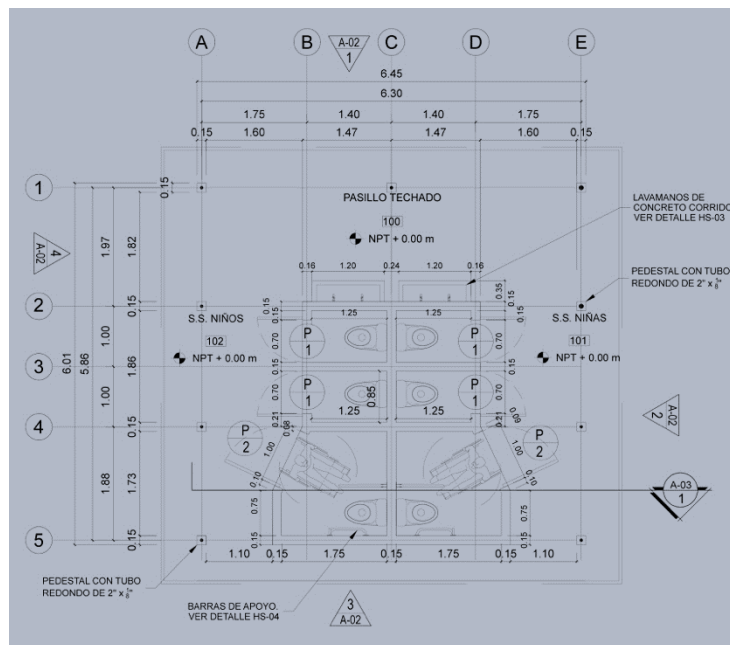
Planta Arquitectónica del Pabellón 4: Batería Sanitaria, Fuente: Área de Preinversión MINED
